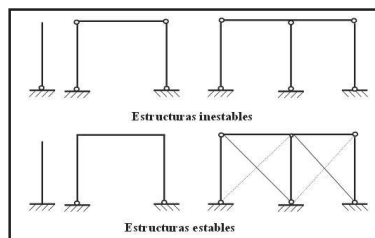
ESTRUCTURA FLEXIBLE Y ESTRUCTURA RÍGIDA
